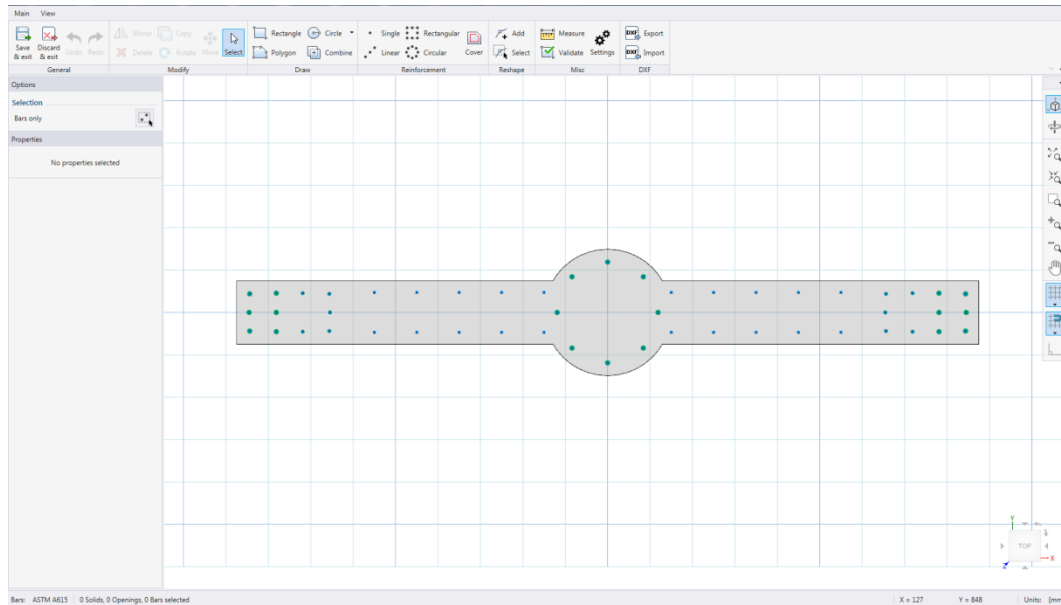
Geometría y disposición de acero de refuerzo, muro C-7
